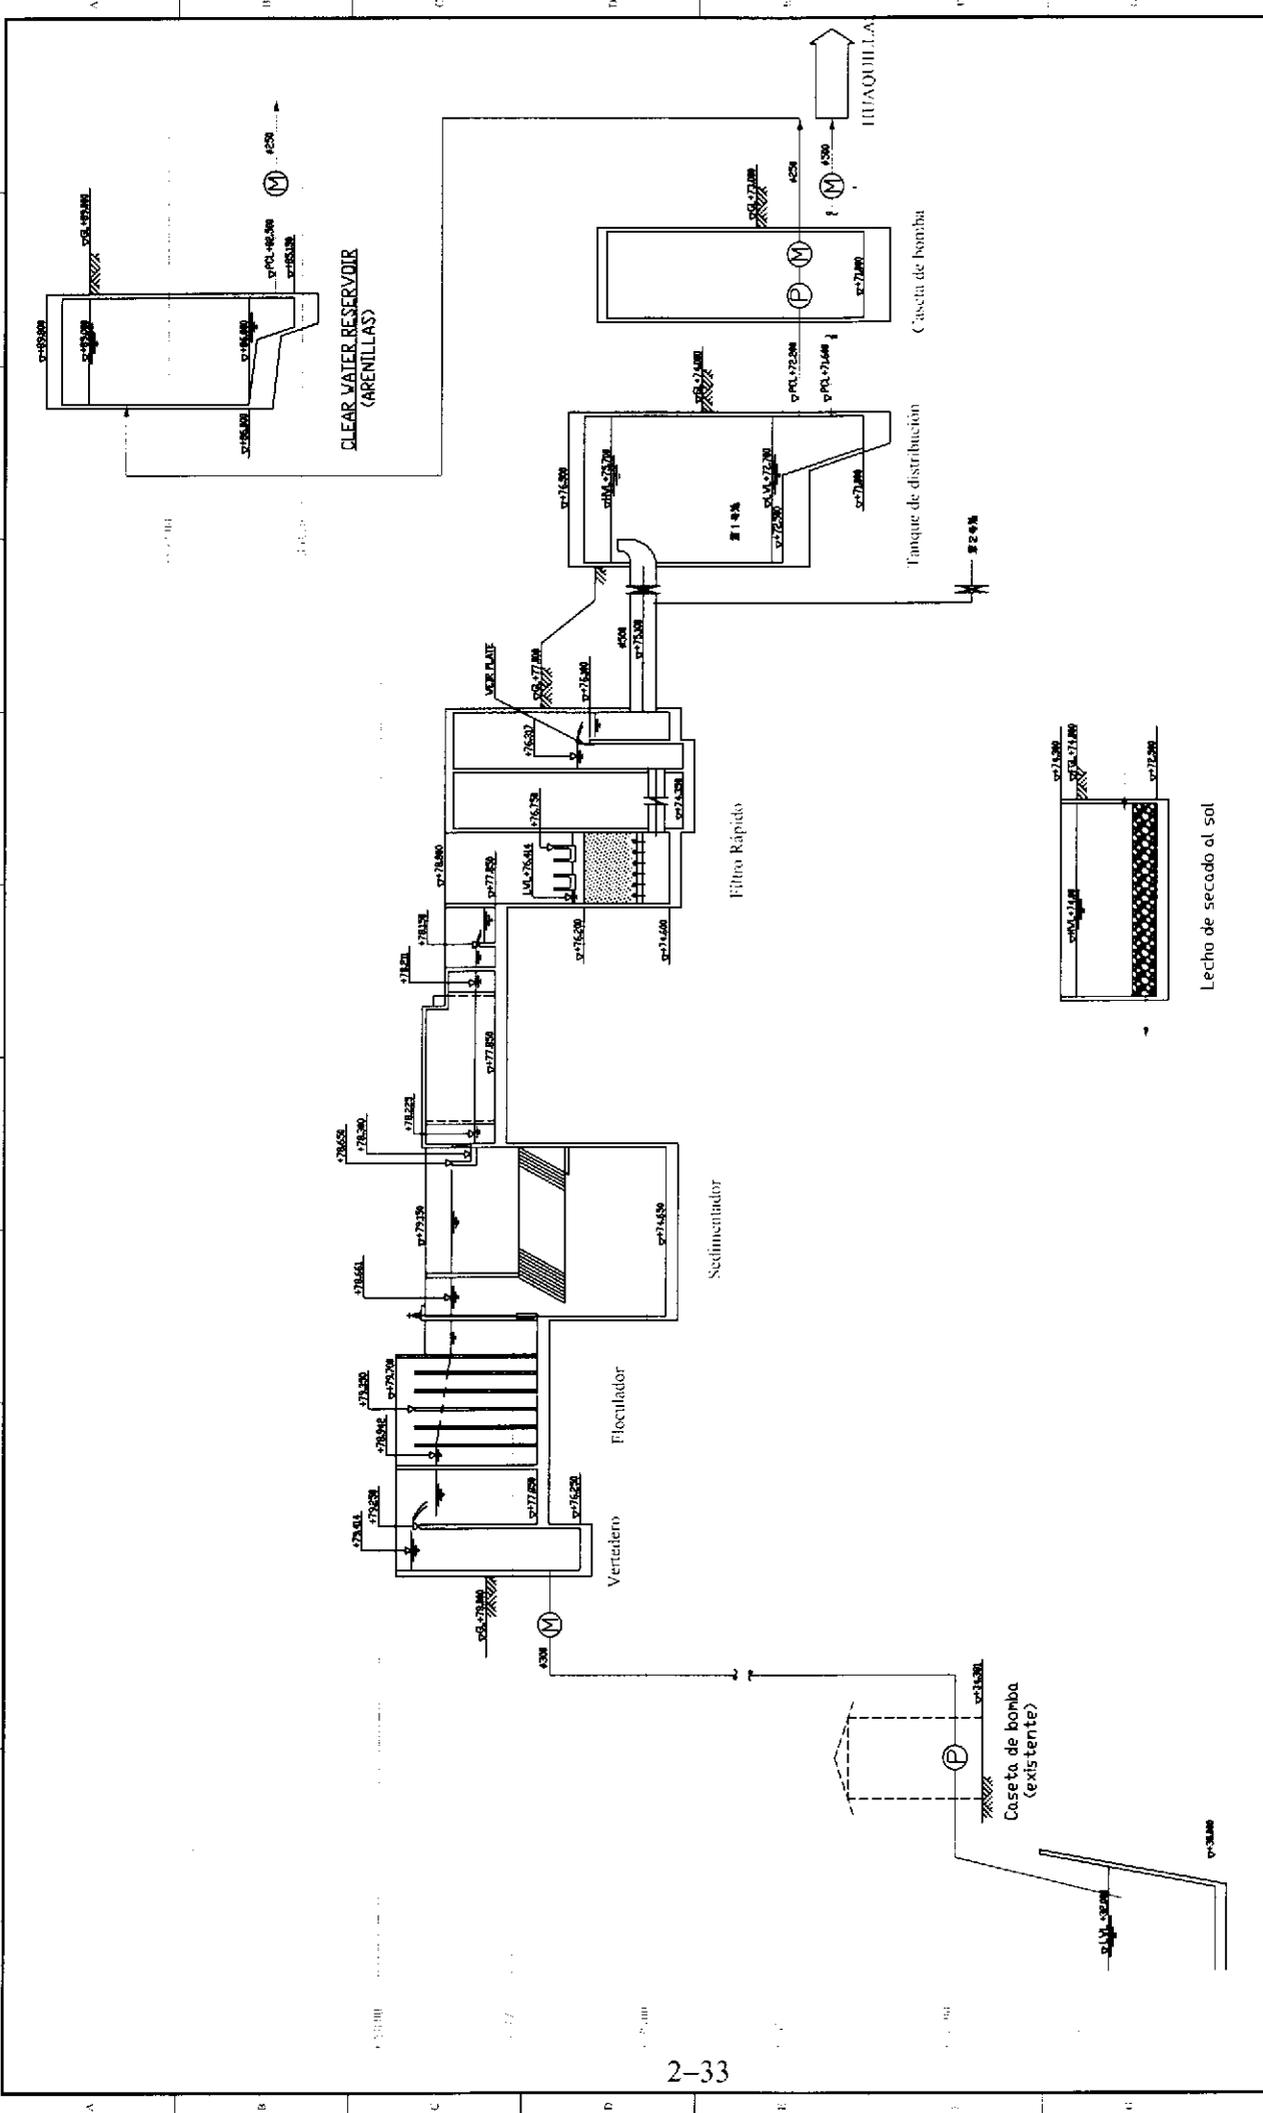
10(1) Plano básico de la planta de Tratamiento de agua
